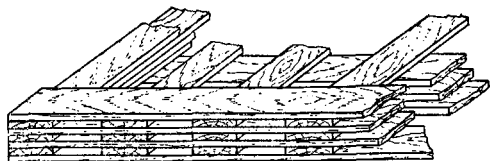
Укладка пиломатериалов в рядовой штабель на прокладках из тех же досок и брусков (заподлицо с торцами досок или брусков)
